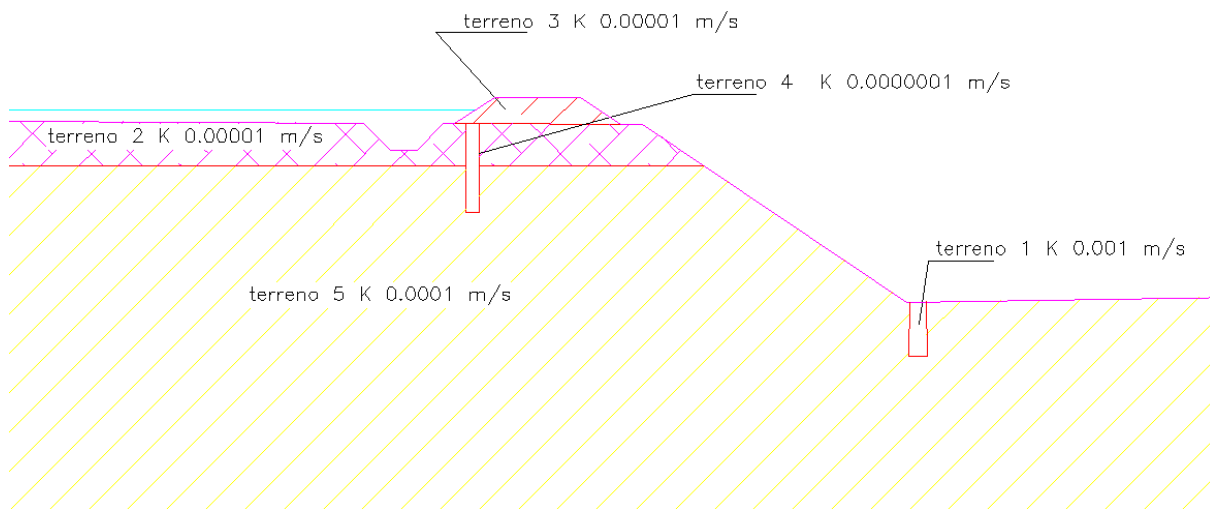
schema di verifica alla filtrazione del rilevato a protezione delle trincee
